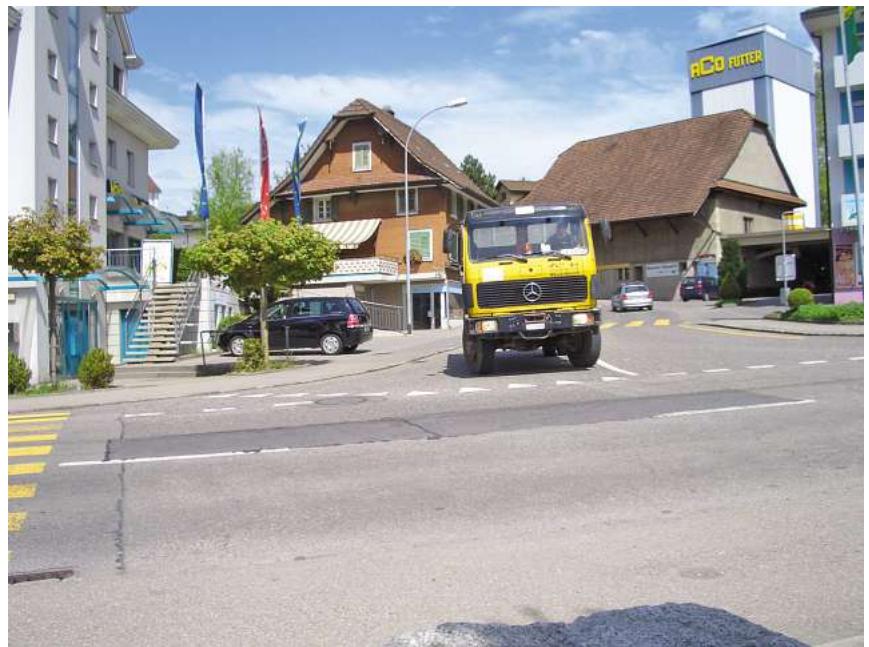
Einmündung K 49b Schlierbacherstrasse
